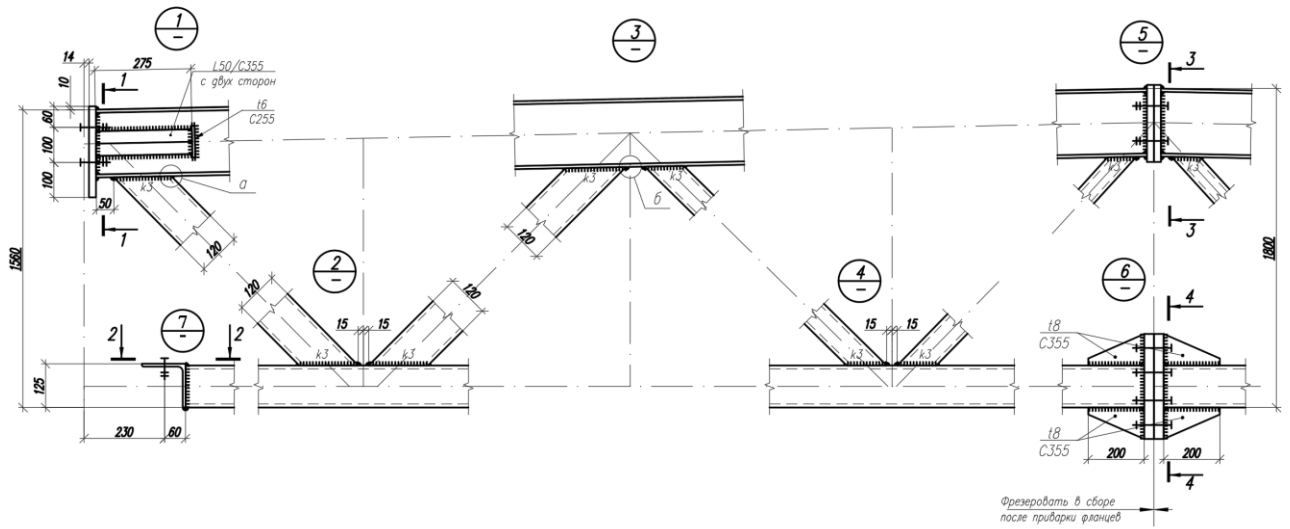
Узлы фермы ФС-24/2-1,95.
